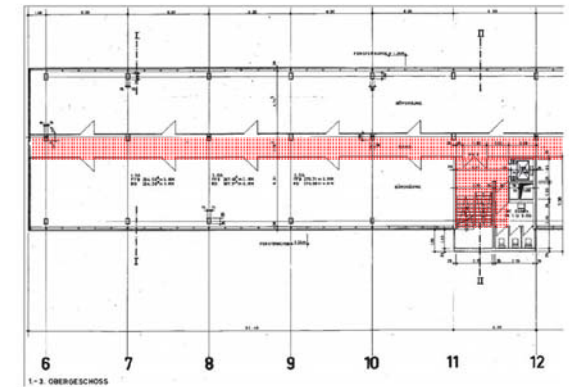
Regelgeschoss - Grundriss 1.OG
